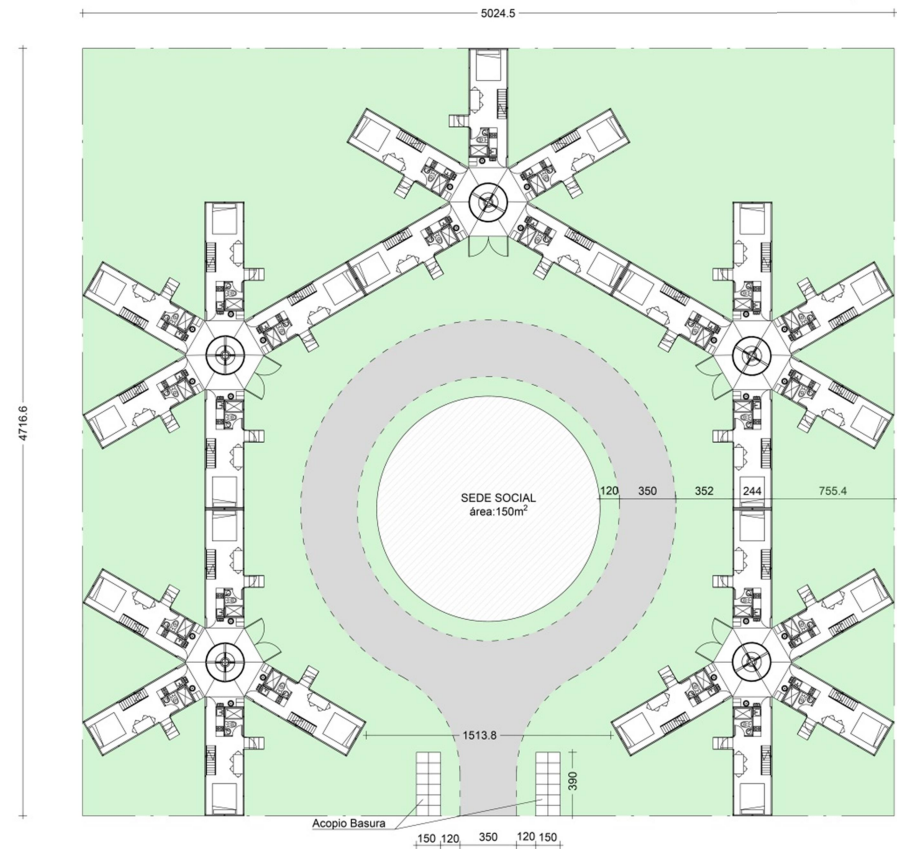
Planta esquemática conjunto mayor y espacio central compartido.
